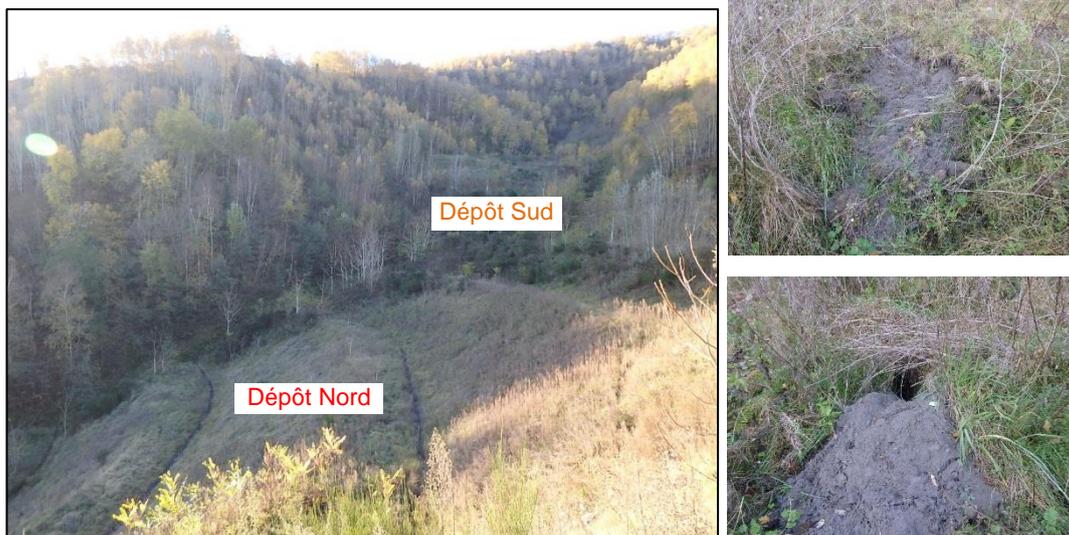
Dépôt de Joany à Viviez - État des banquettes, dépôts nord et sud en novembre 2017 (à gauche) et traces d'affouillement sur dépôt sud (en haut à droite) terrier sur dépôt nord (en bas à droite).
